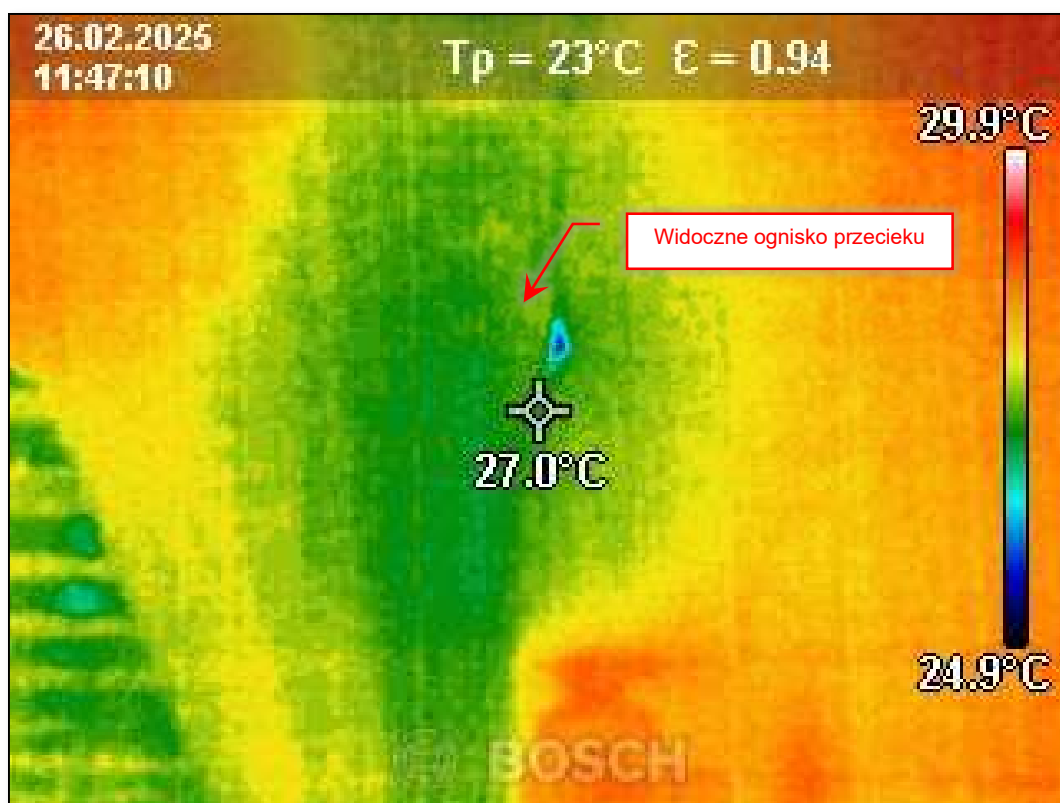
Inwentaryzacja zawilgocenia konstrukcji na skutek przerwania hydroizolacji. (fot. Rafał Fit)
